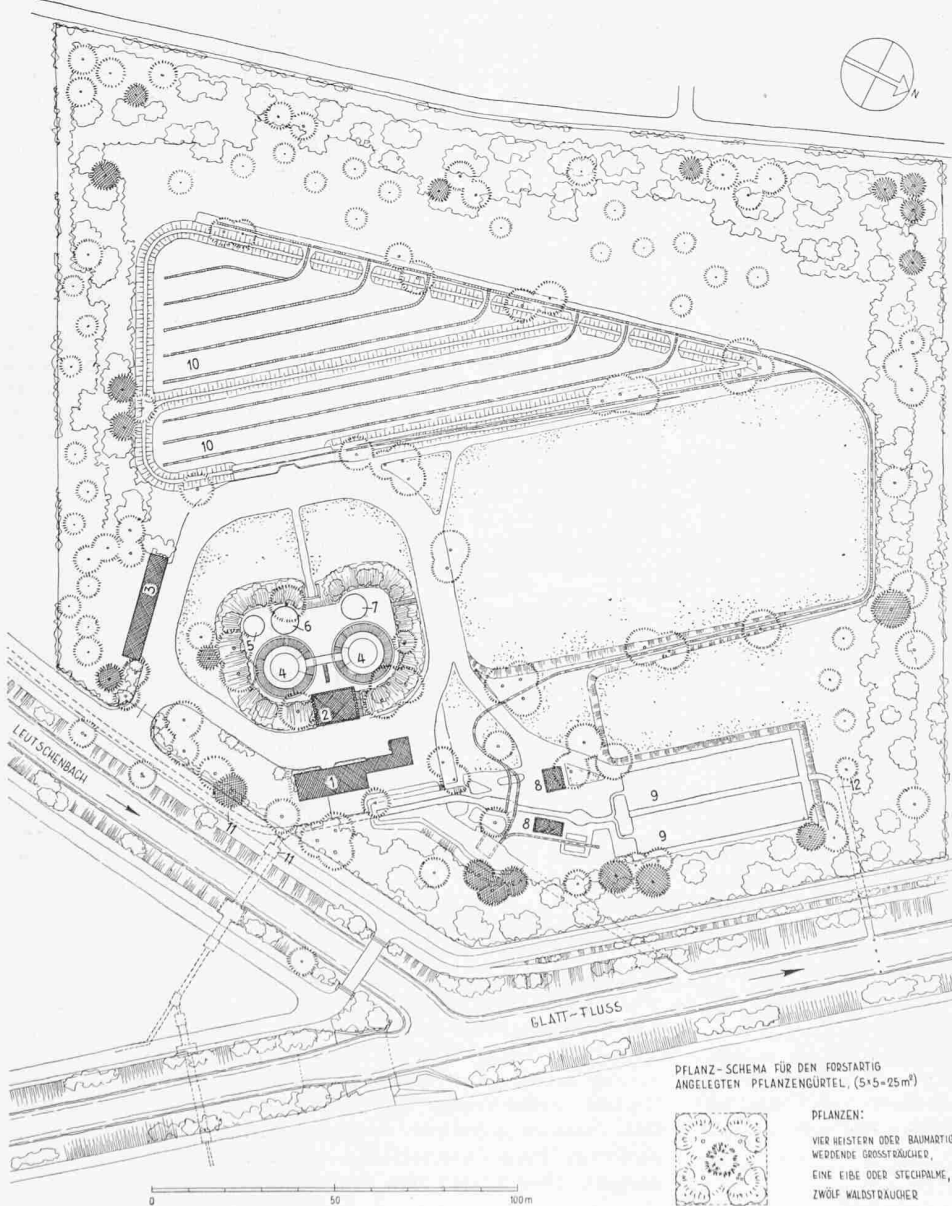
Kläranlage der Stadt Zürich an der Glatt; Lageplan 1:2000
